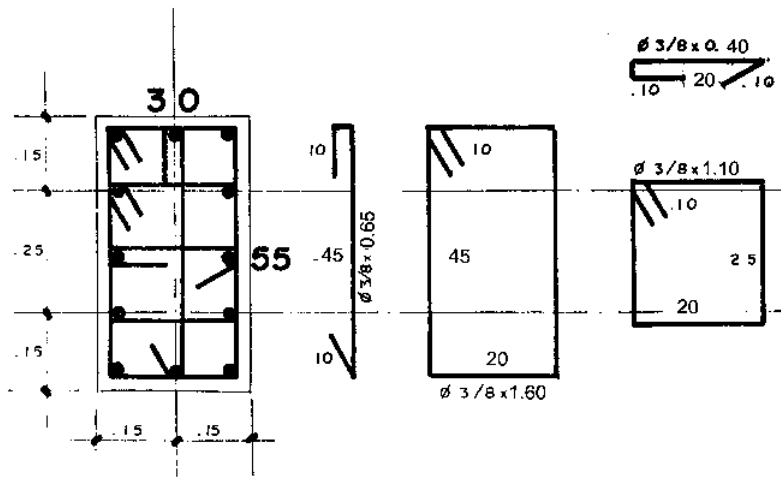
Ejemplo de acero de refuerzo transversal en columnas
